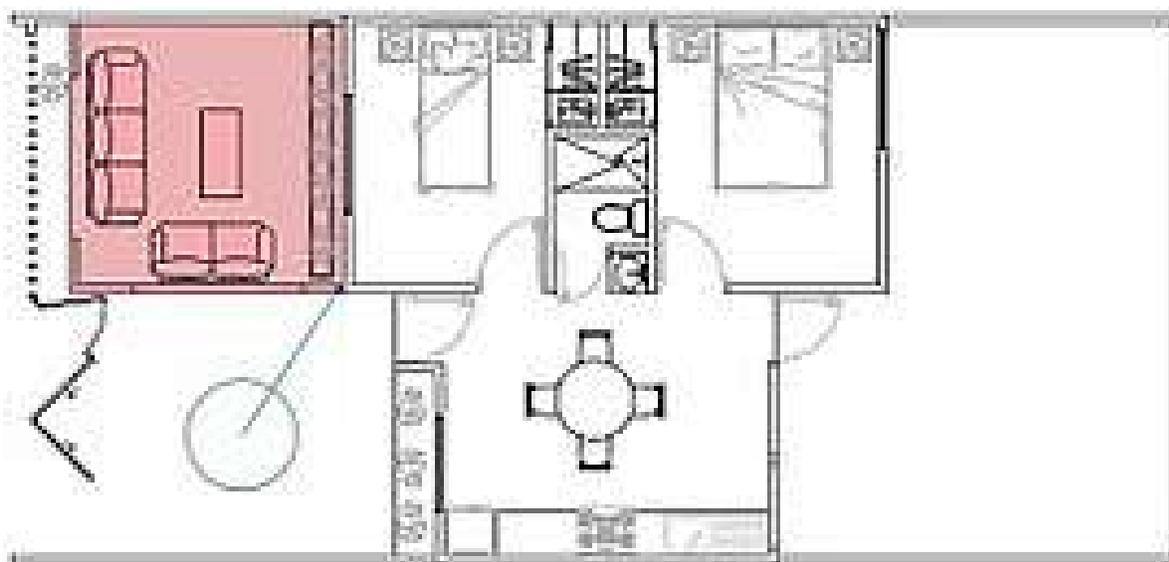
Planta arquitectónica de propuesta de área de estancia.
